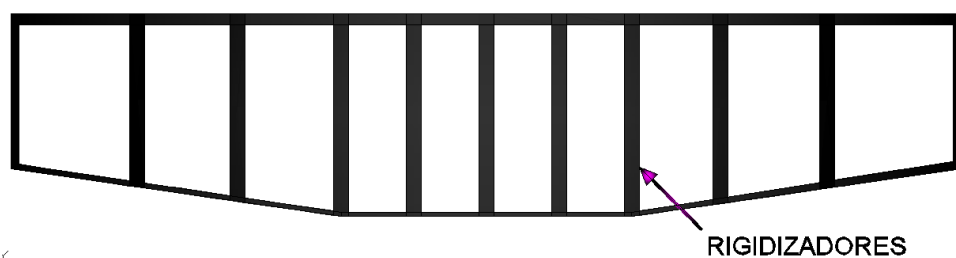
Rigidizadores externos de la viga (vista frontal de la viga)
